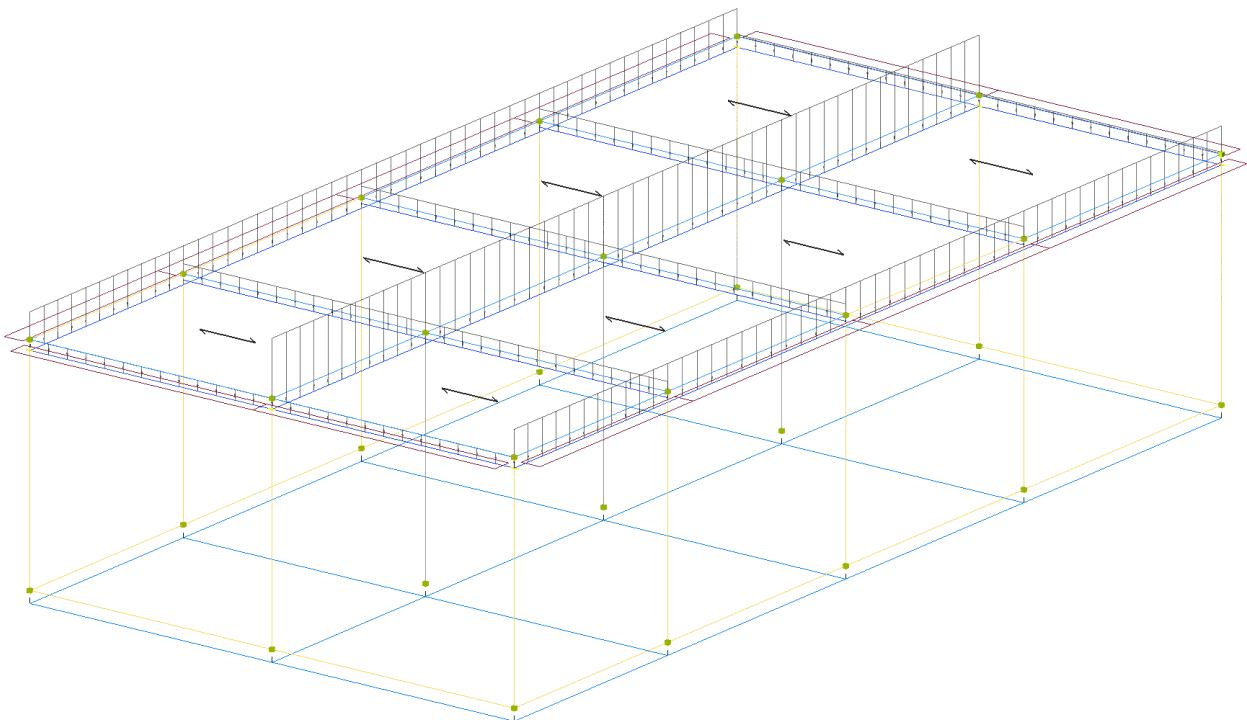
Applicazione carico permanente non strutturale solaio (QFissi solai).
